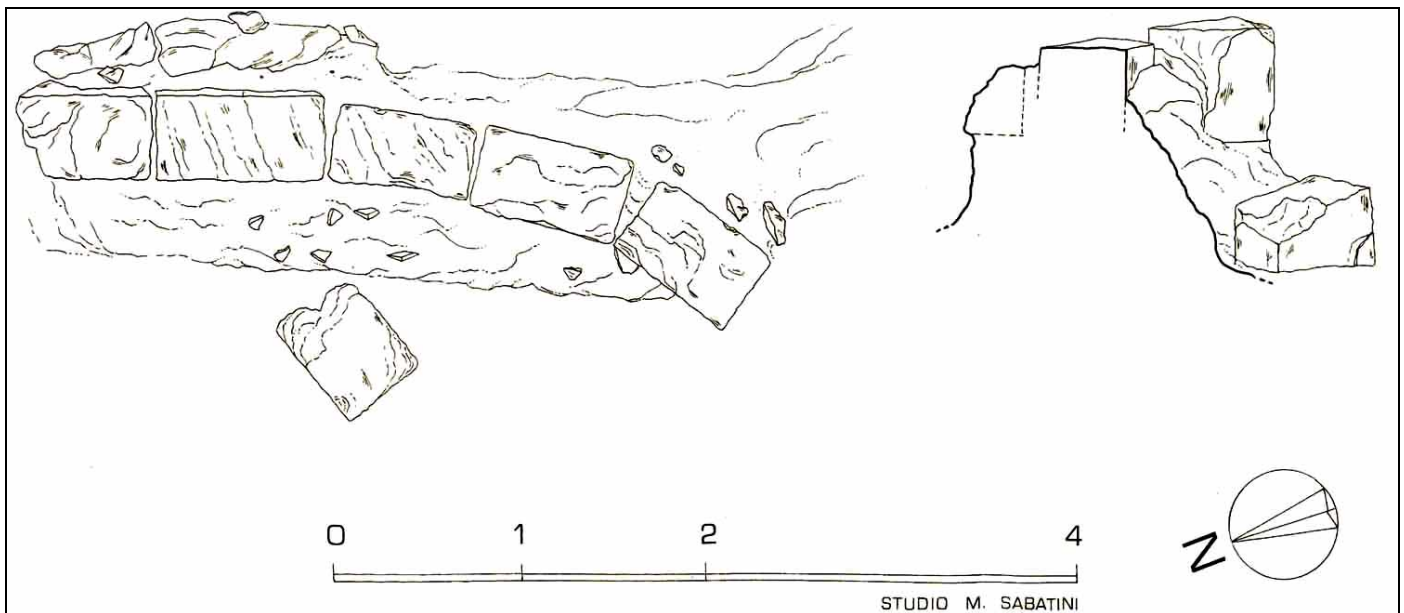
Pianta e sezione prospettica (orientata N/S) del muro curvilineo (archivio S.A.R.).
